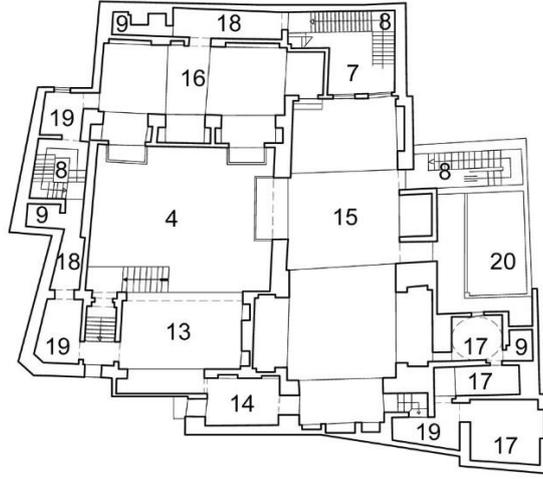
مسقط أفقي للدور الأرضي بمنزل زينب خاتون.
